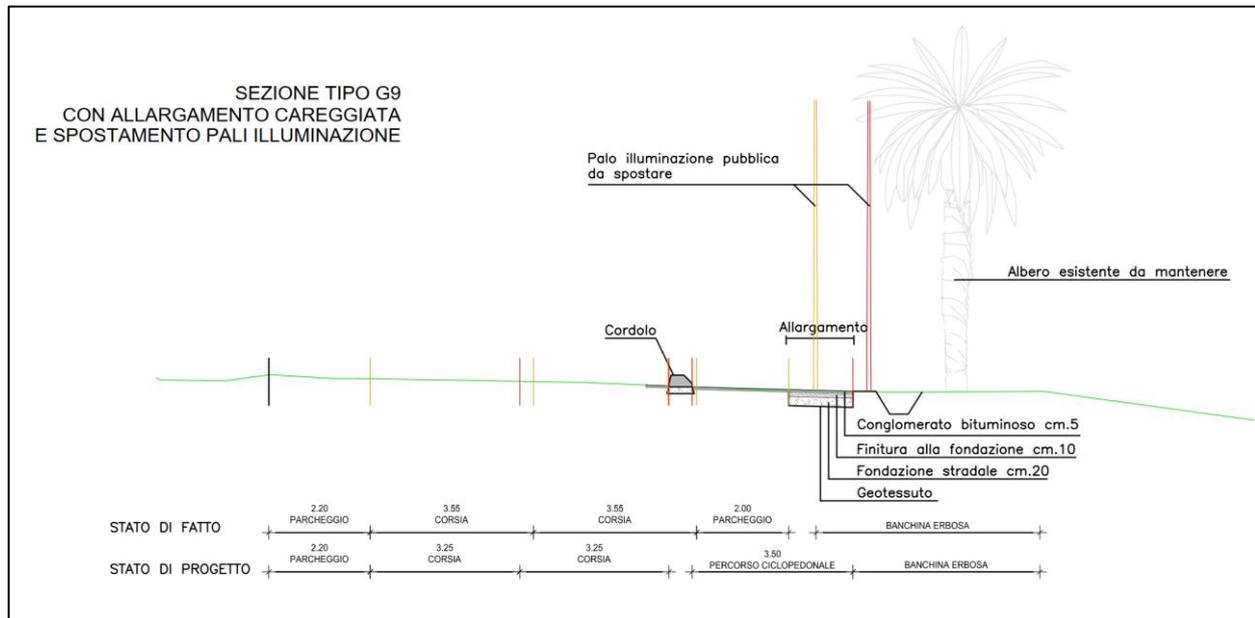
Profilo sezione tipo G9 con allargamento carreggiata
